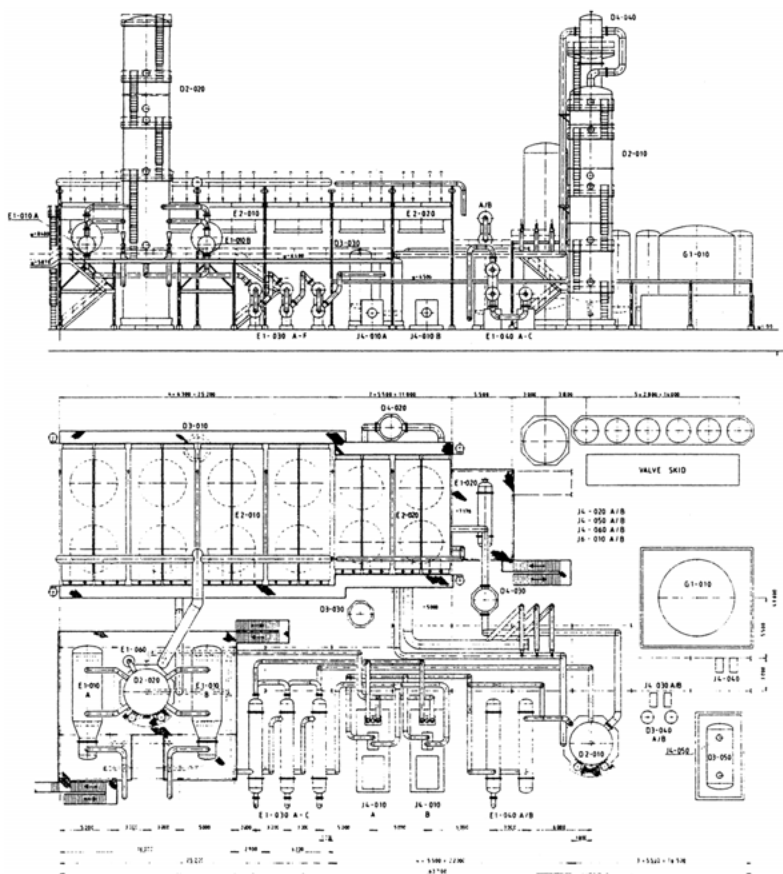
Plan général d'implantation pour une installation pétrochimique.
